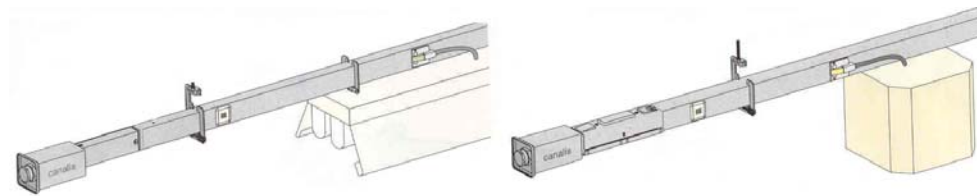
Canalizações Pré-fabricadas para Distribuição da Iluminação.
